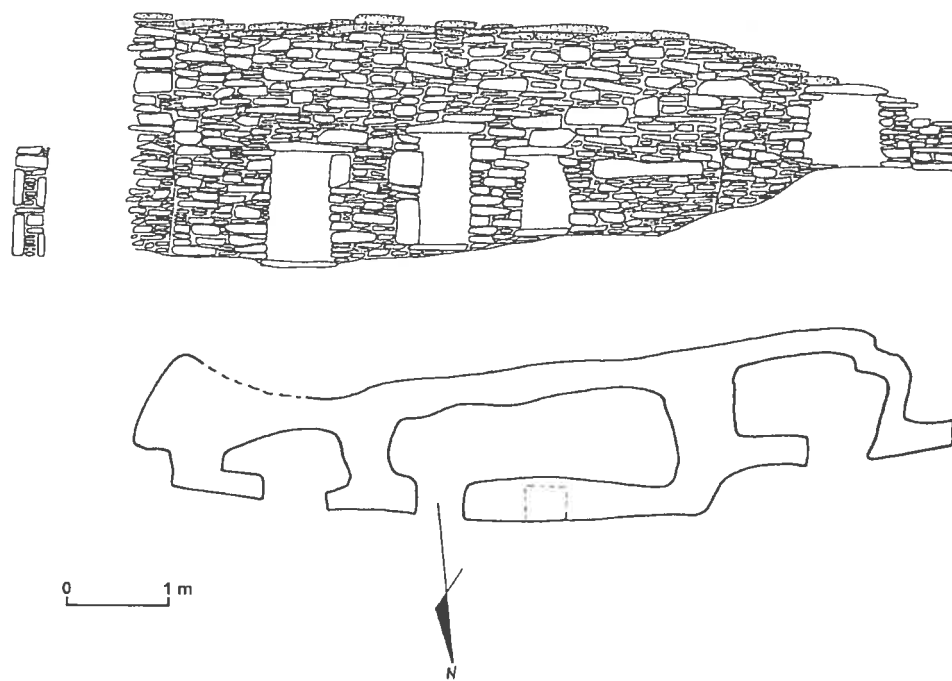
Plan et façade d'un groupe de trois *chullpas* de type A du secteur II de Rapayan.
